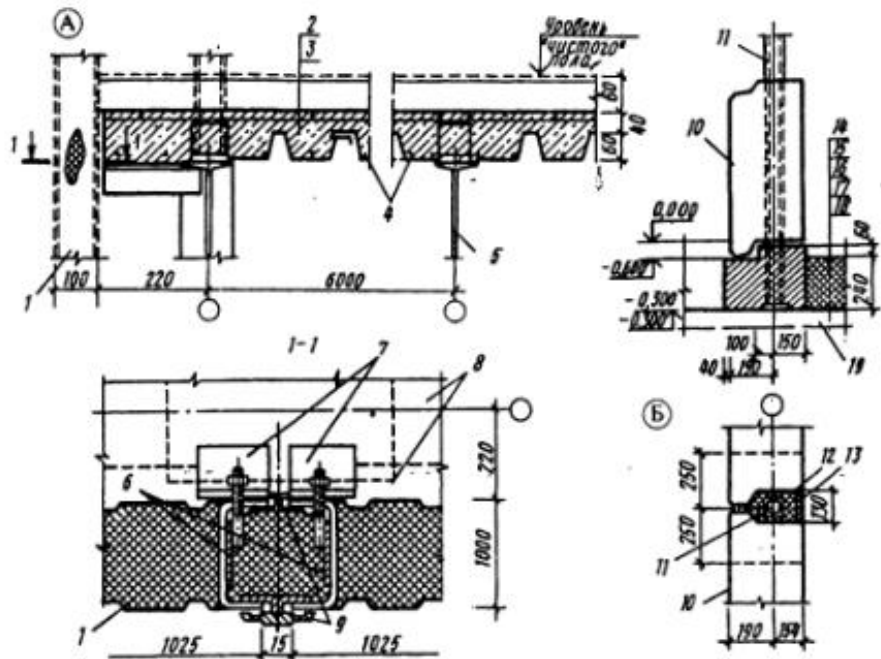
Узлы конструкций здания "Универсама": А – фрагмент перекрытия антресольного этажа, Б – установка стоек фахверка в стыках цокольных панелей; 1 – металлические панели ограждения; 2 – конструкция пола; 3 – монолитная железобетонная плита перекрытия антресольного этажа; 4 – стальной профильный настил; 5 – несущие балки перекрытия; 6 – текстолитовая прокладка; 7 – стальные монтажные элементы; 8 – конструкции фахверка; 9 – алюминиевый нащельник; 10 – цокольная керамзитобетонная панель; 11 – стойки фахверка; 12 – пакет пенополистирола, обернутый толем; 13 – цементно-песчаный раствор; 14 – плитка керамическая на цементно-песчаном растворе ( $\delta=30$  мм); 15 – цементно-песчаная стяжка ( $\delta=15$  мм); 16 – гидроизоляция из двух слоев толя ( $\delta=5$  мм); 17 – плоский асбестоцементный лист ( $\delta=10$  мм); 18 – утеплитель из постекла ( $\delta=20$  мм); 19 – железобетонная монолитная плита
